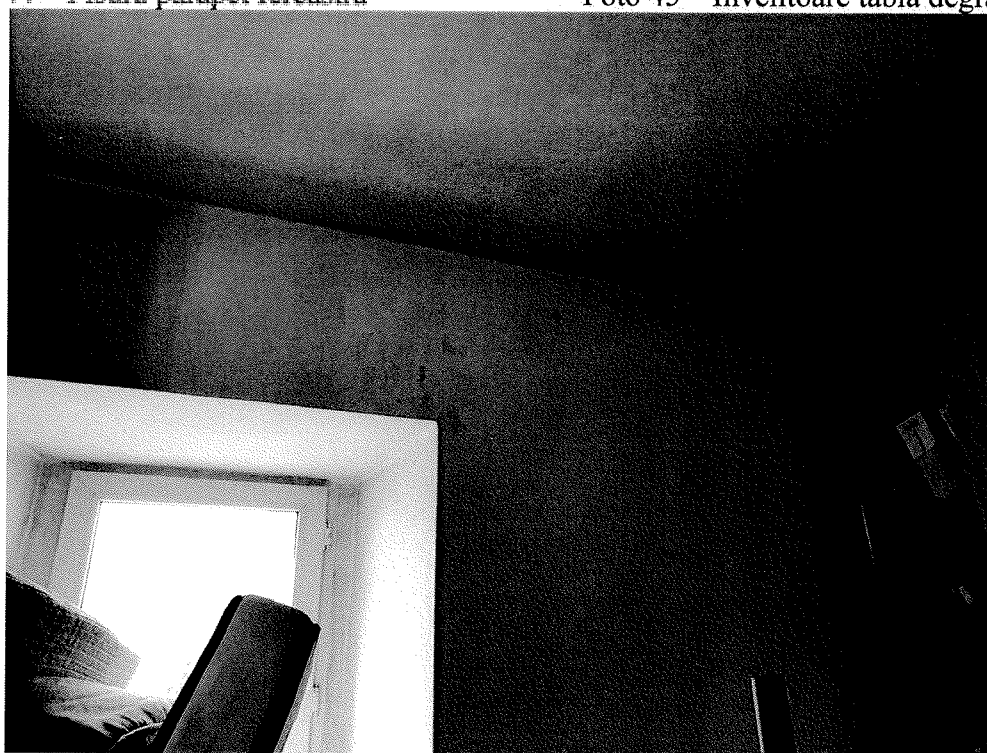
Infiltrații apărute pe interior la nivelul intersecțiilor dintre planșee și zidurile exterioare ca urmare a pătrunderii apelor pluviale prin discontinuitățile de la nivelul fațadelor
